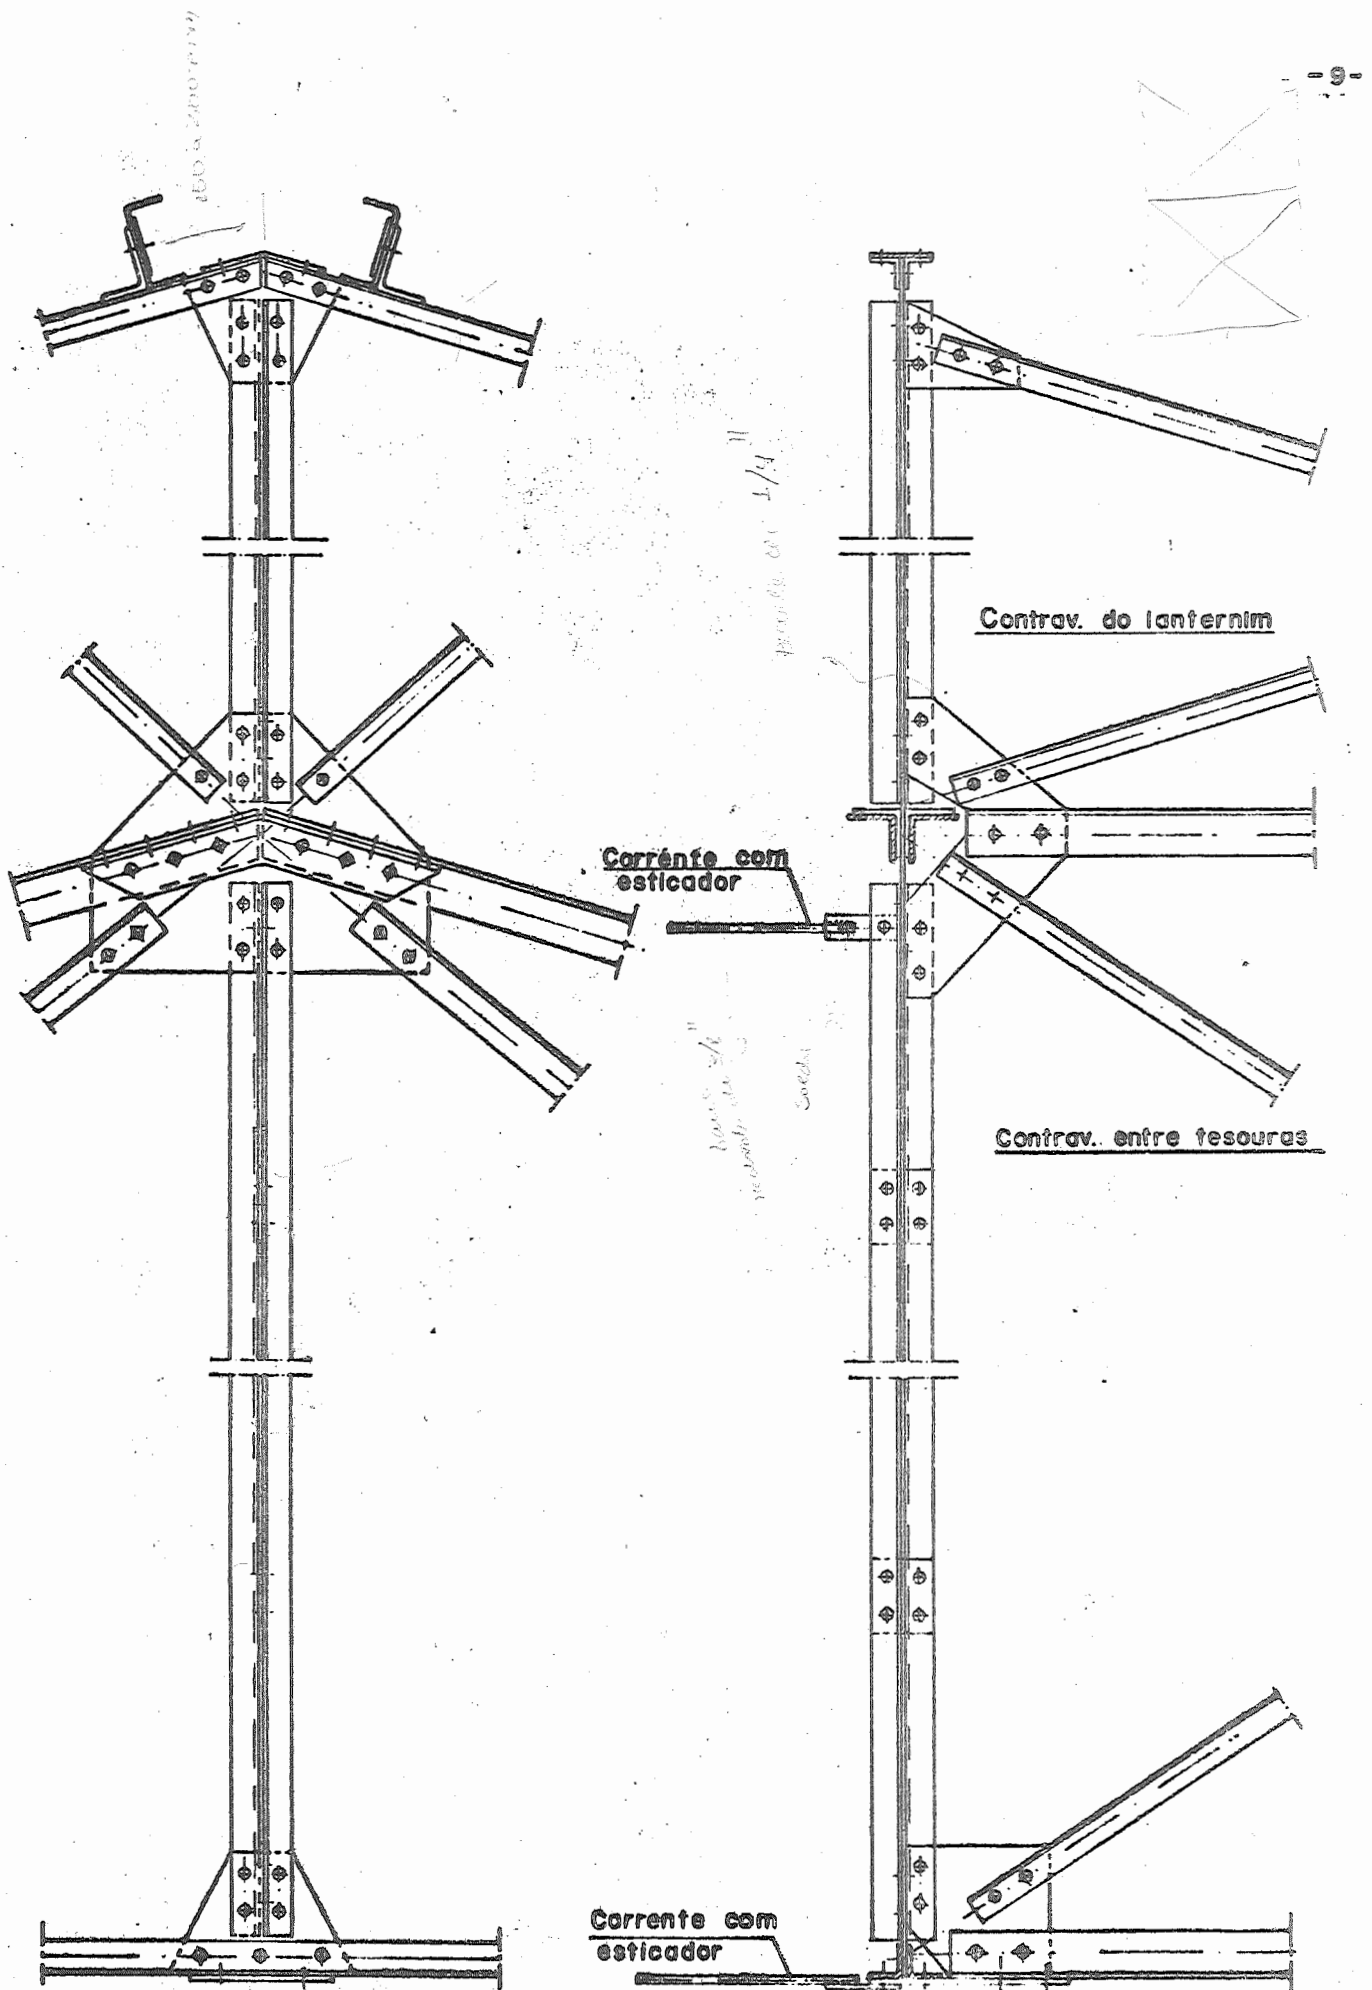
4 - CONTRAVENTAMENTOS VERTICAIS ENTRE TESOURAS
